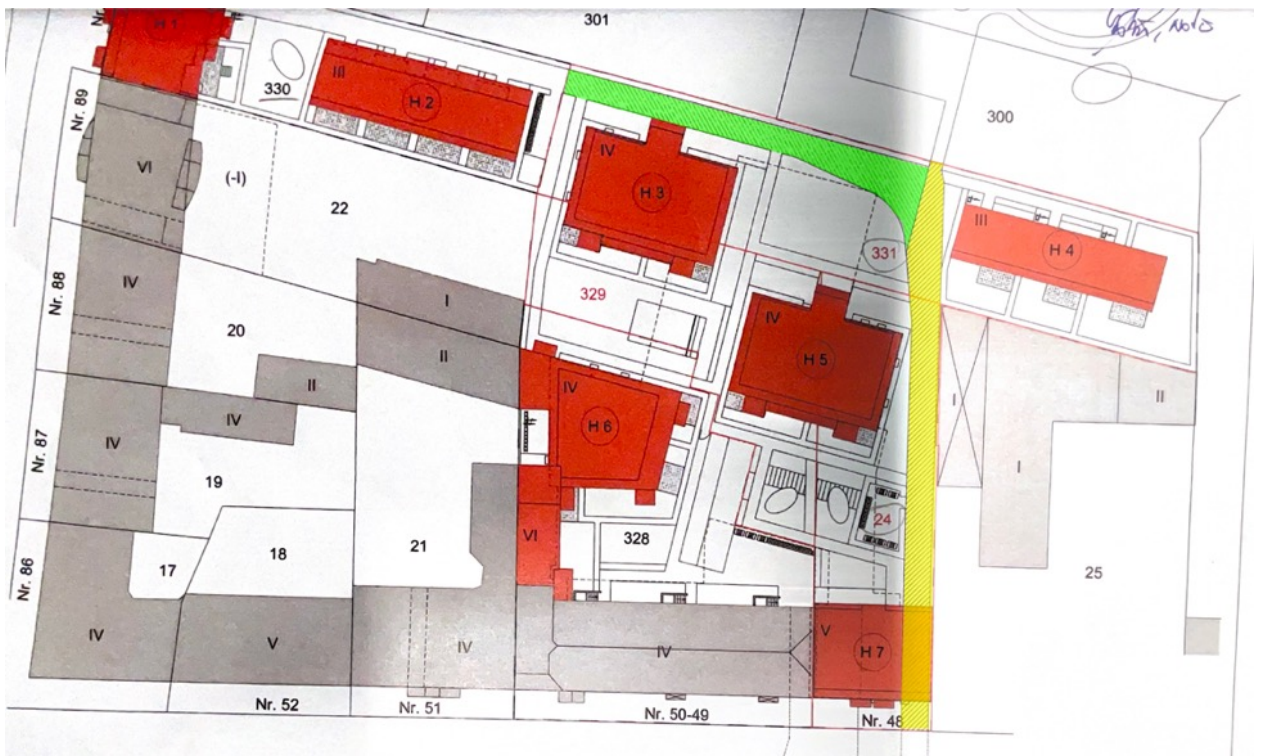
Anlage zur UR 1114/2020 Notar Philip Grün, Berlin, mit Darstellung der belasteten Flächen (gelb = rechtsschraffiert, grün = linksschraffiert)
